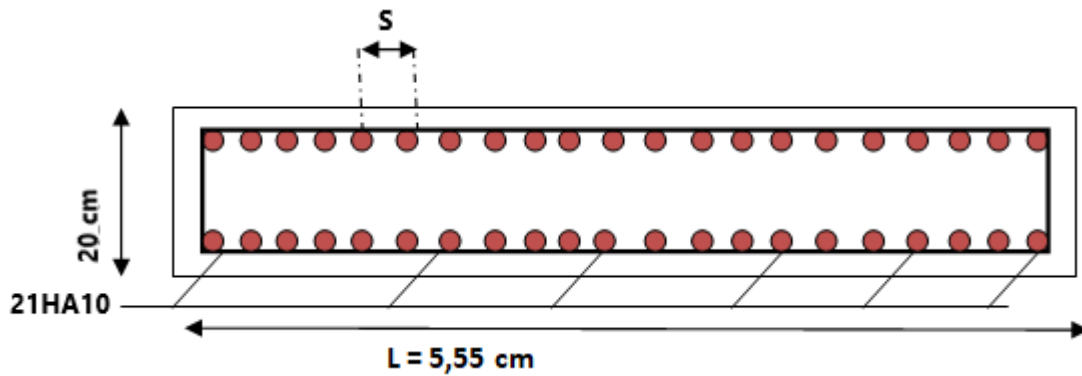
Schéma de ferrailage du voile v_{x1}.
